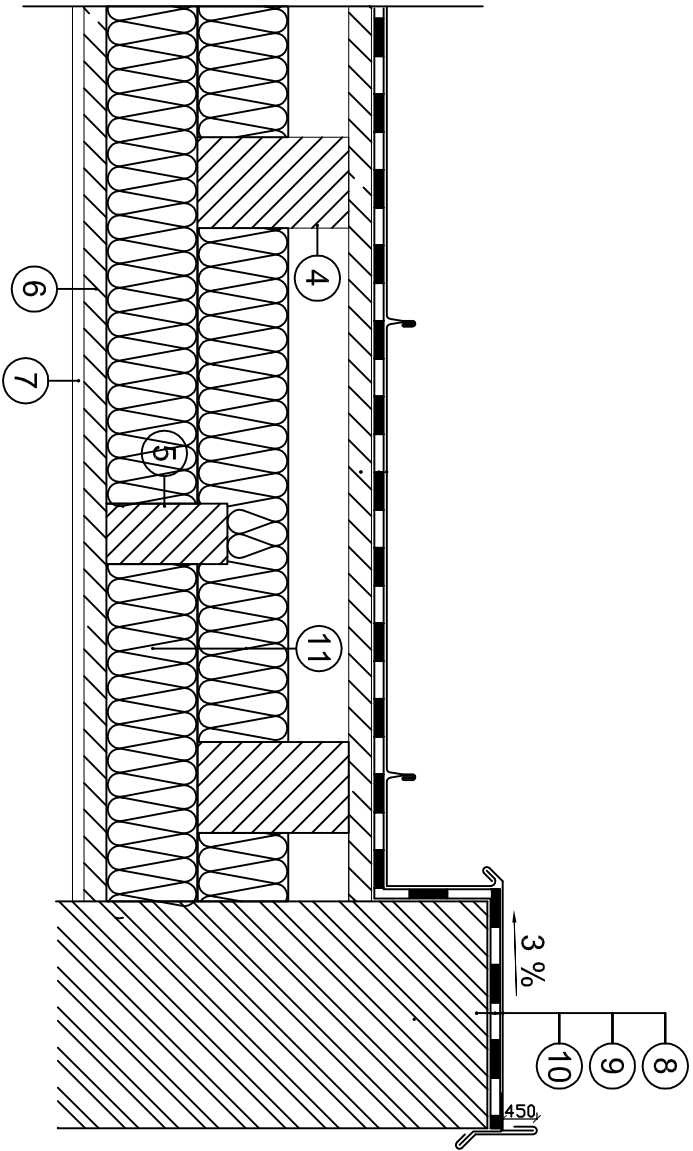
DETAIL F - VÝMĚNA KRYTINY PŘÍSTAVBY Č.1 M 1:10
